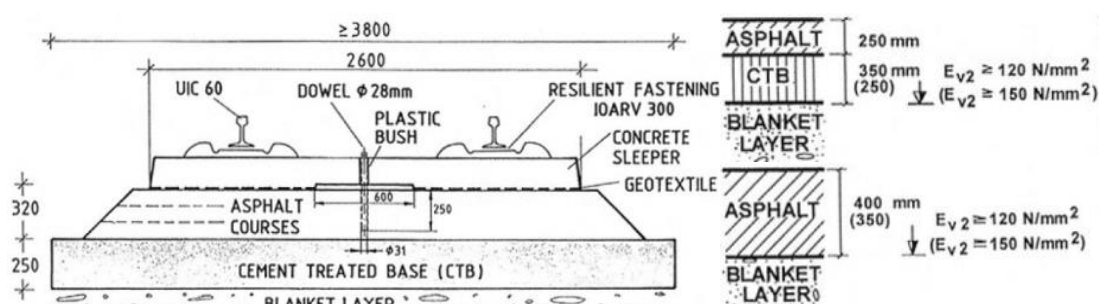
Perfil transversal esquemático da solução WALTER e as estruturas alternativas (Leykauf et al., 2006b)
